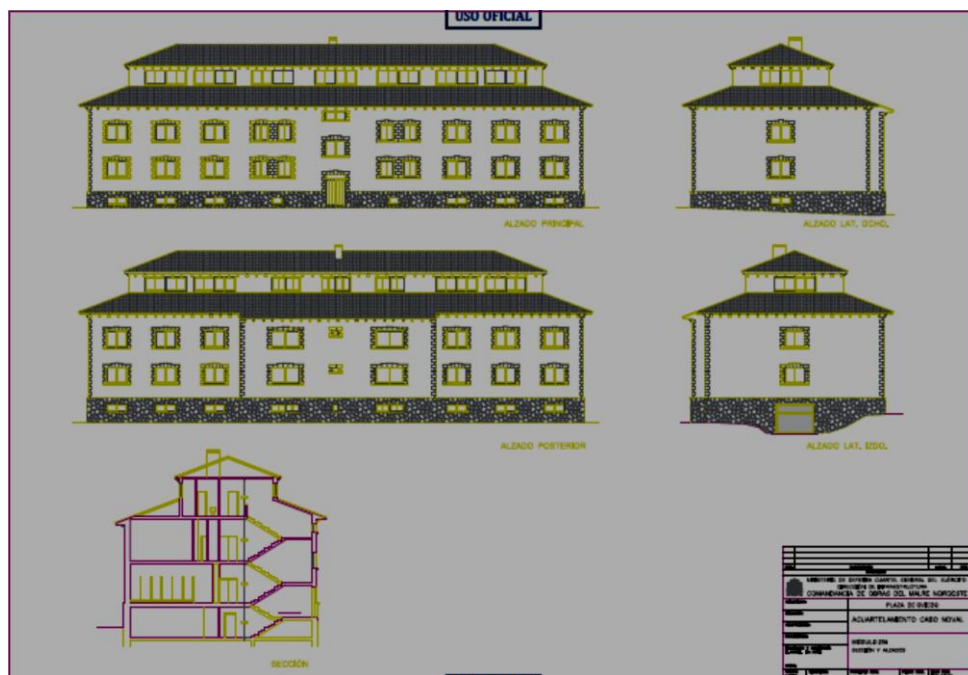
Plano edificio alojamiento. Fuente: Plan de mantenimiento 2019
